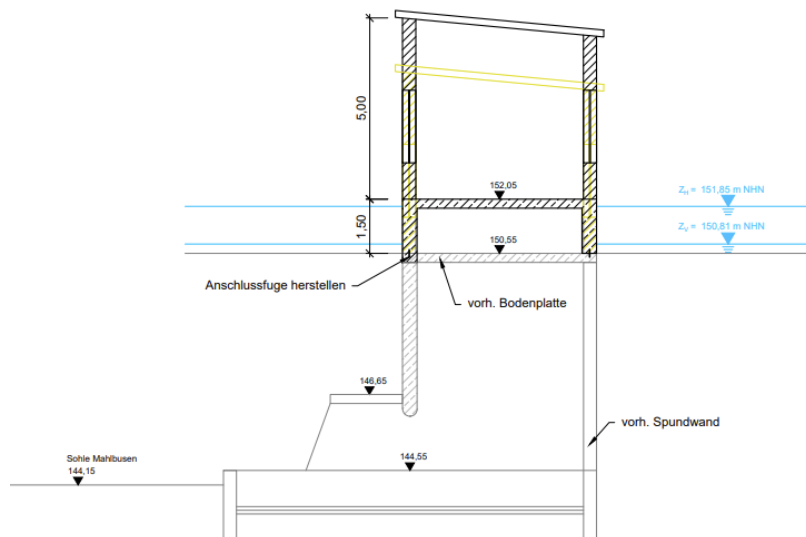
Variante 2 – Ausschnitt aus Plan-Nr. TO13-5.1, Abriss gelb (Höhen in m NHN (2016))
